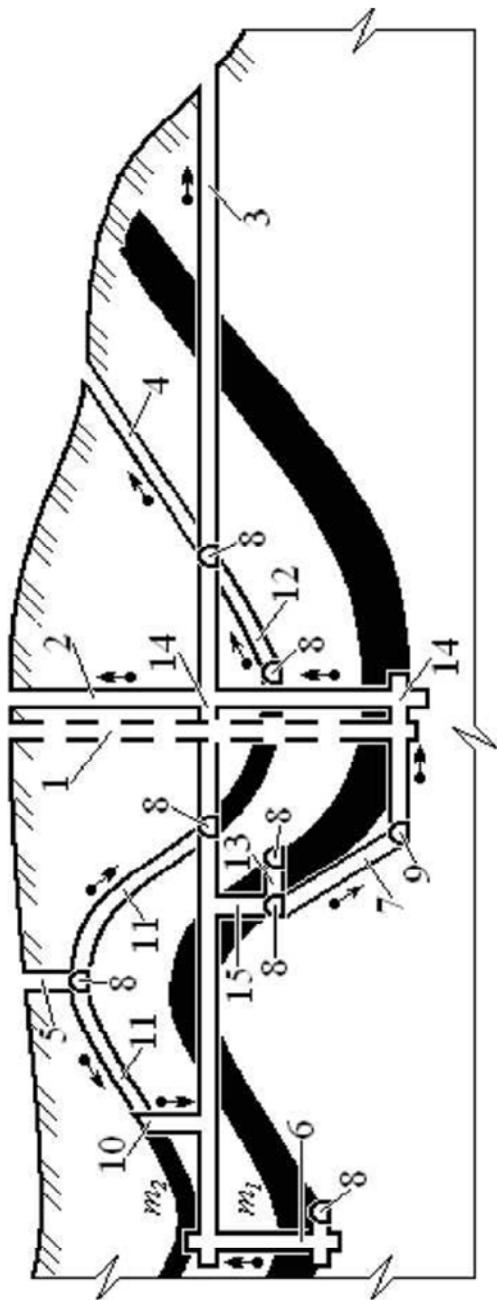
Схема расположения подземных горных выработок при разработке пластовых залежей (разрез вкрест простирания)
